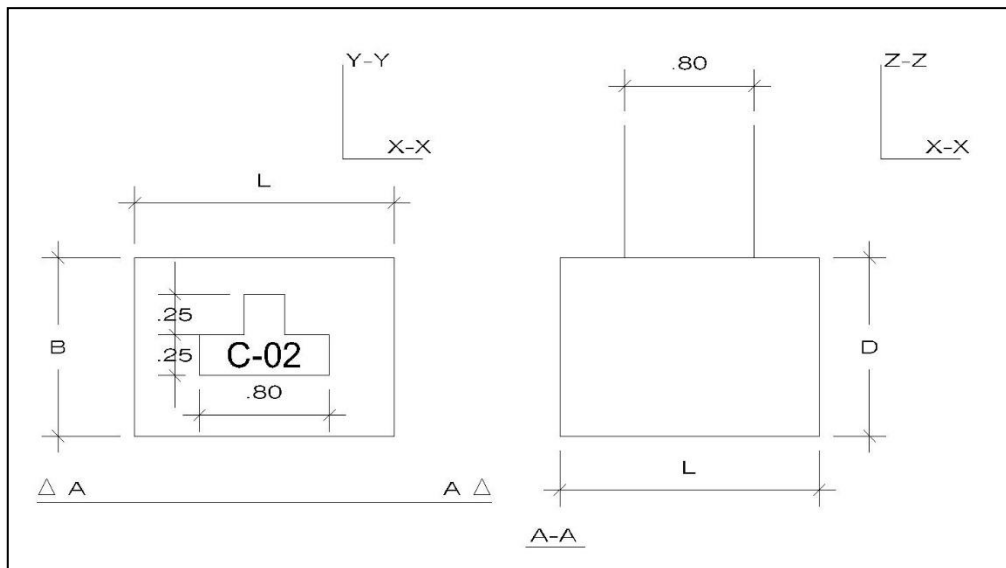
Esquema para el diseño de la zapata de la columna C-02 ubicada en los ejes 2 y F.
